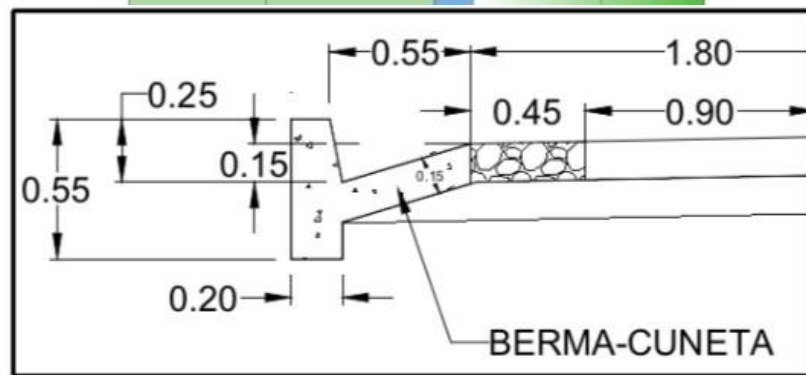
Detalle de la Cuneta. Fuente: Guía de Diseño de Pavimentos
